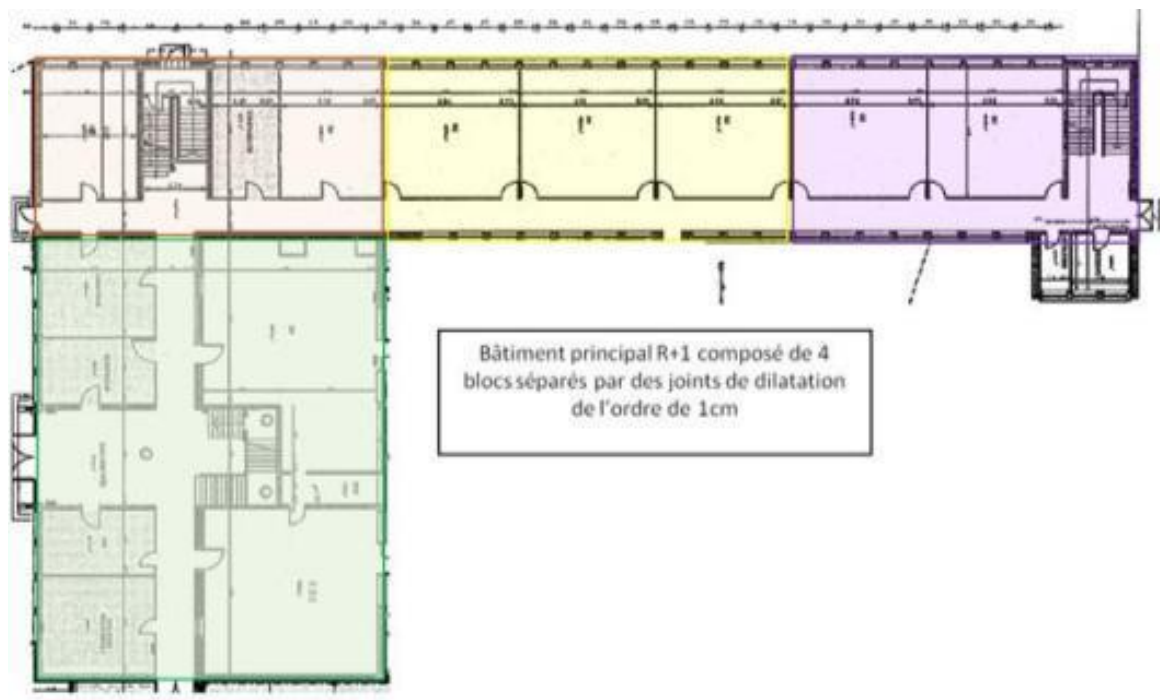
Vue en plan schématique du bâtiment principal R+1 avec les 4 blocs de bâtiment.
